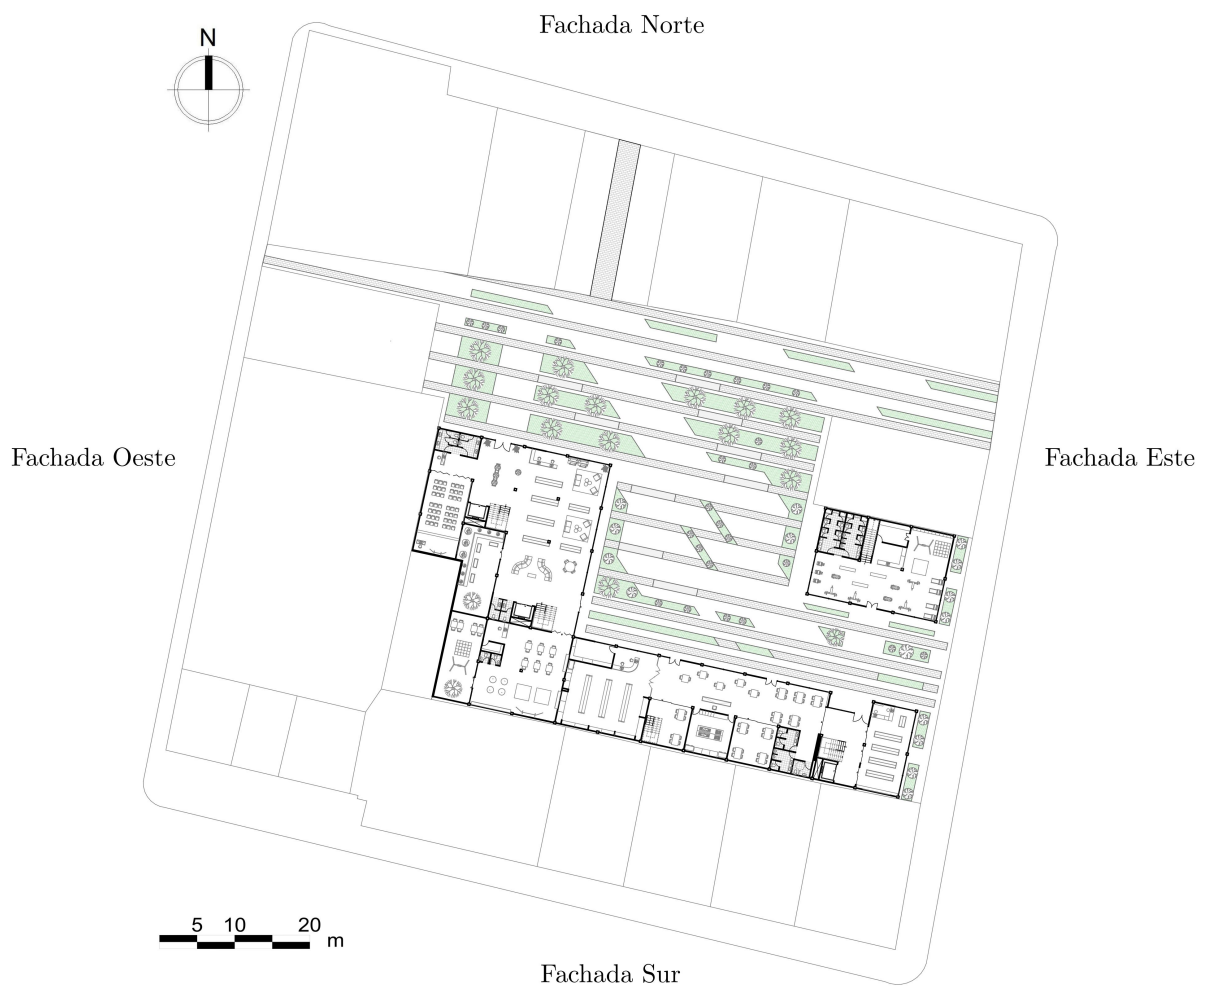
Orientación del Proyecto. Fuente y elaboración: Autores
